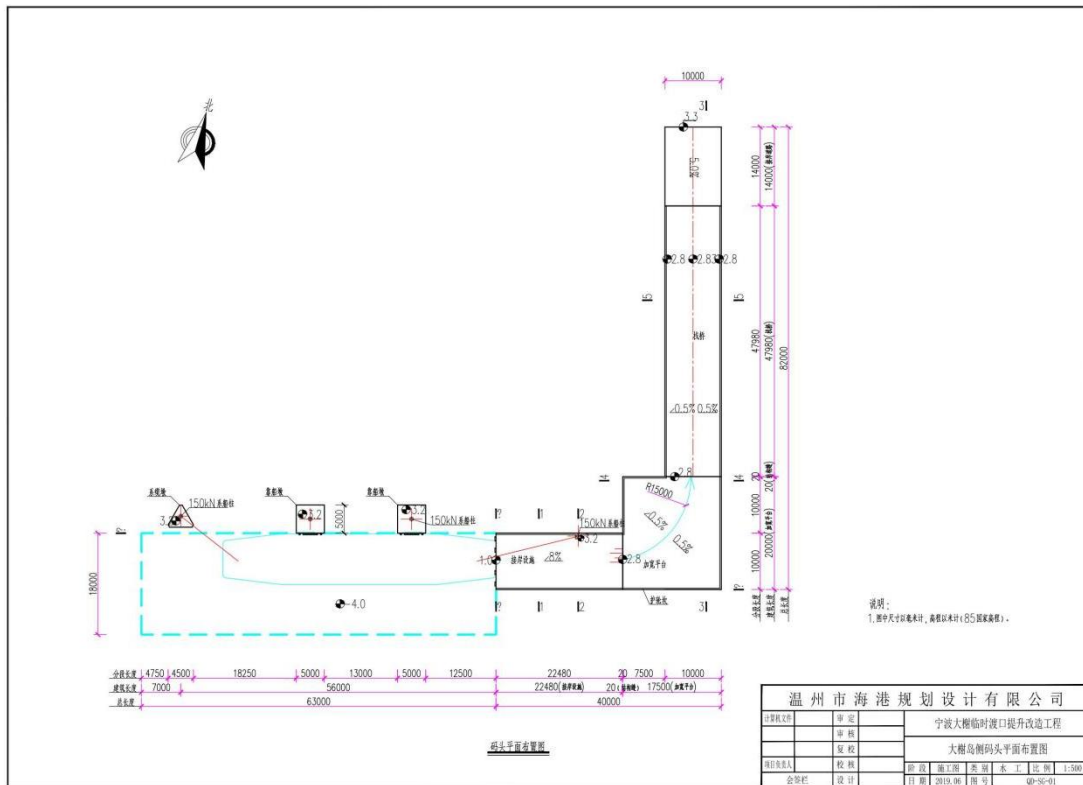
大榭岛侧汽渡码头平面布置图
